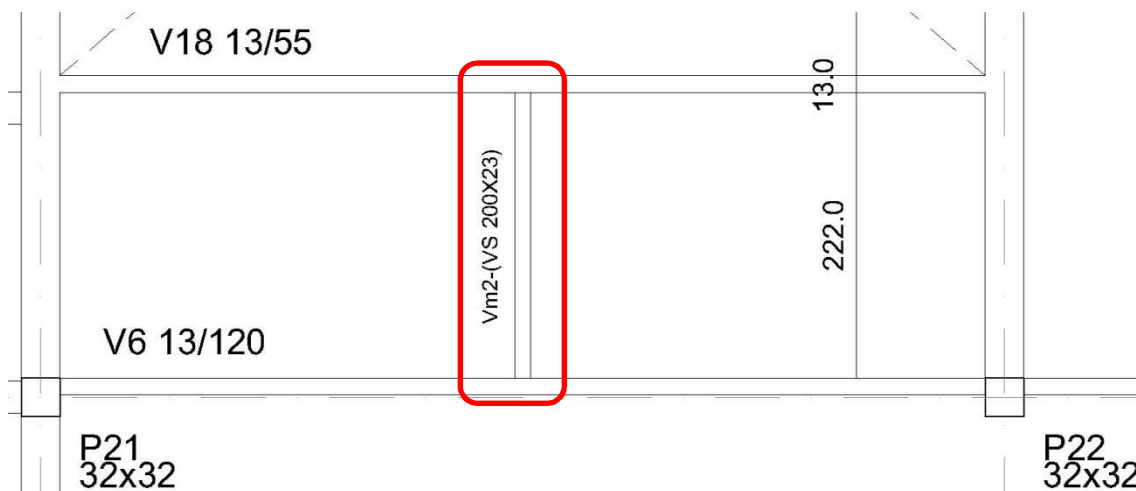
Planta de reforço estrutural da laje, em destaque a viga Vm2 (viga metálica de reforço) apoiada nas vigas de concreto V6 e V18.
